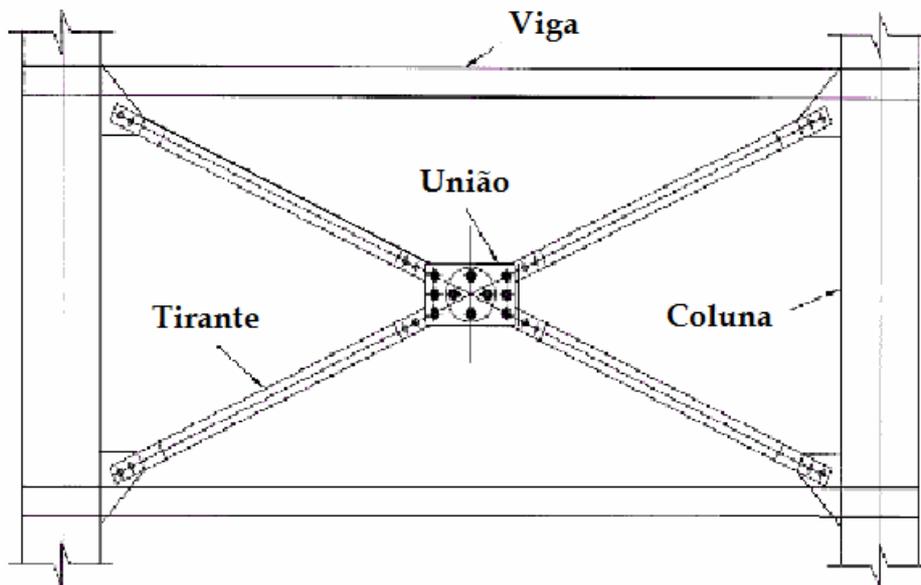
Contravento em “Cruz de St.º André” [7]
